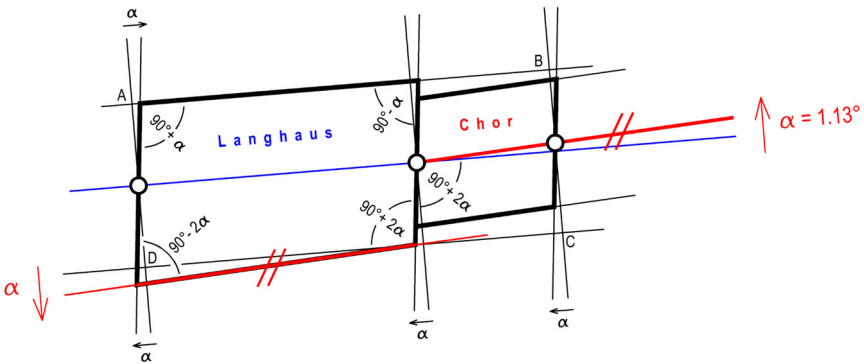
Pfarrkirche Friedberg, rekonstruierter Grundriss mit Winkelabweichungen vom Grundrechteck A-B-C-D (schematische Darstellung, Winkel α überhöht)
